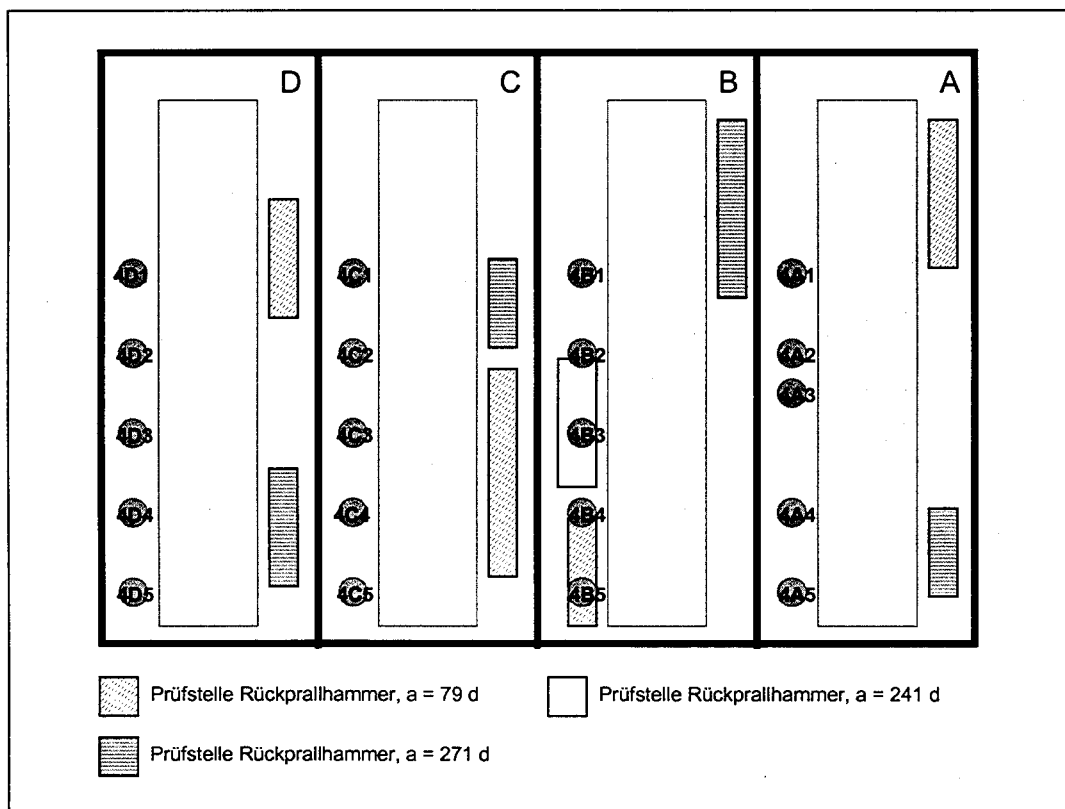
Lage der Prüfflächen am Betonkörper 2
